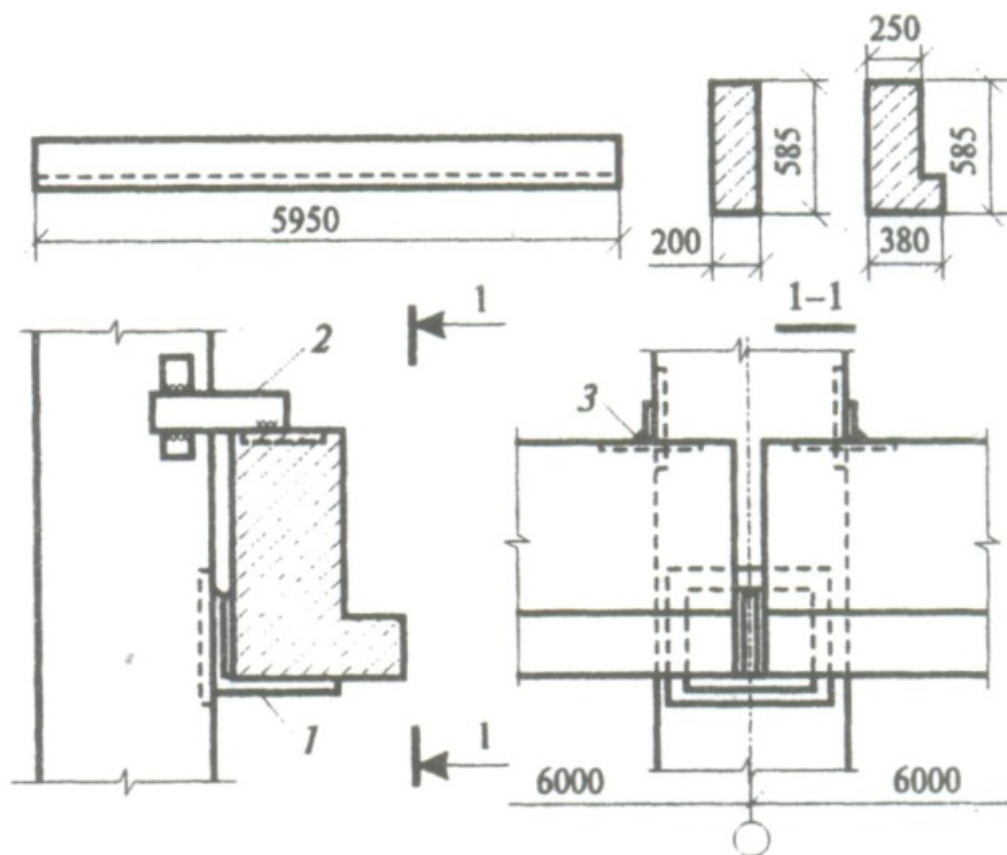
Обвязочные балки и крепление их к колоннам:
